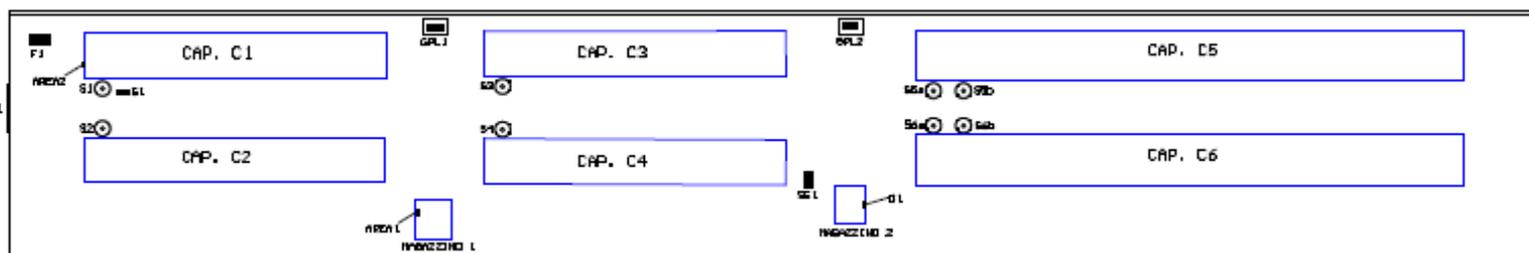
planimetria dell'allevamento (fonte: A. I. A.)
